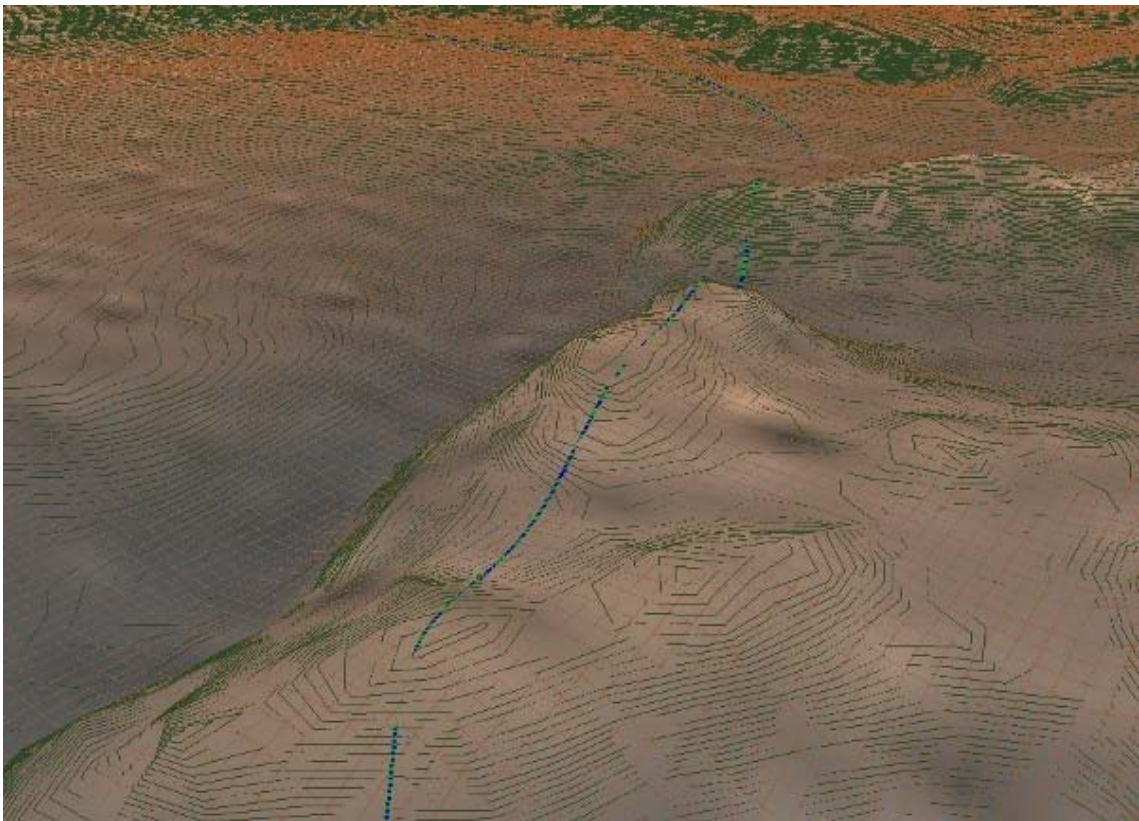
Configuração final apoiada – visão do planalto e vale – duto 16”
